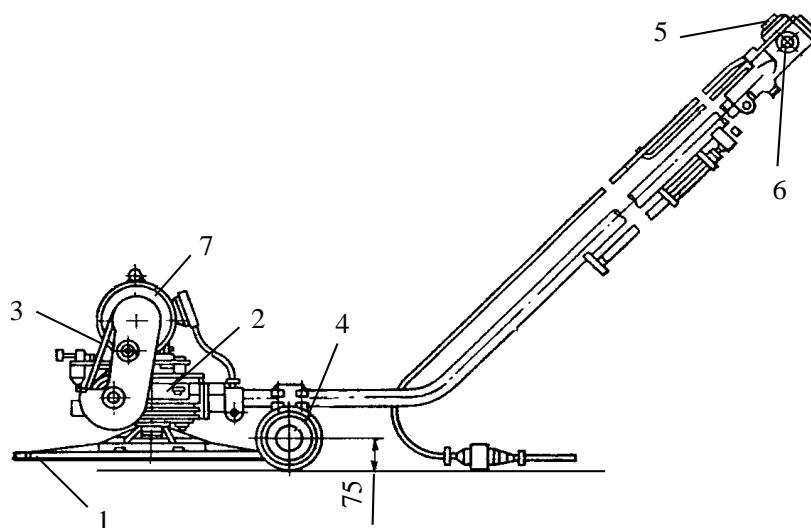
Дисковая заглаживающая машина: 1 – диск; 2 – редуктор червячный; 3 – клиноременная передача; 4 – колеса ходовые; 5 – пускатель; 6 – рукоятка; 7 – электродвигатель
